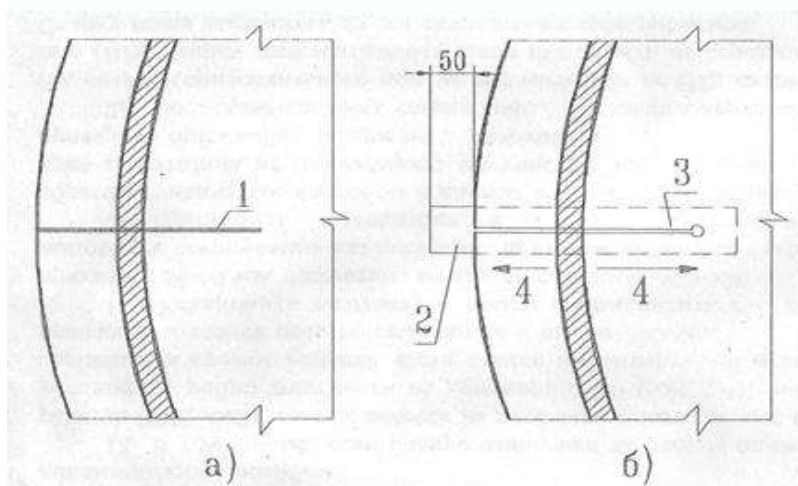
Схема ремонта трещин, располагающиеся под стенкой стенкой резервуара.
